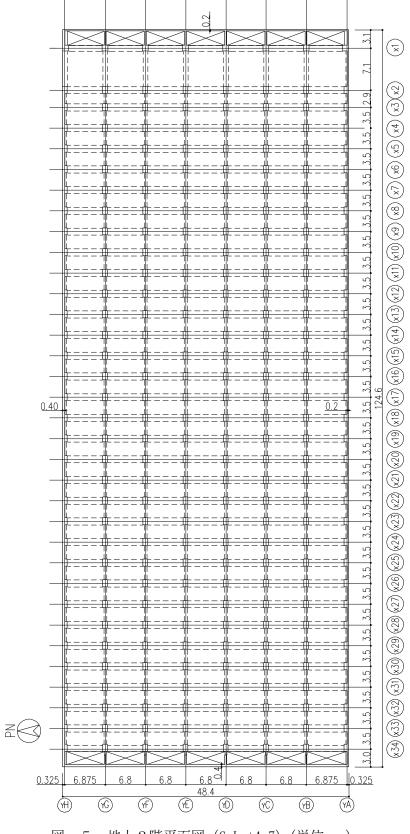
地上2階平面図 (G.L.+4.7) (単位:m)
